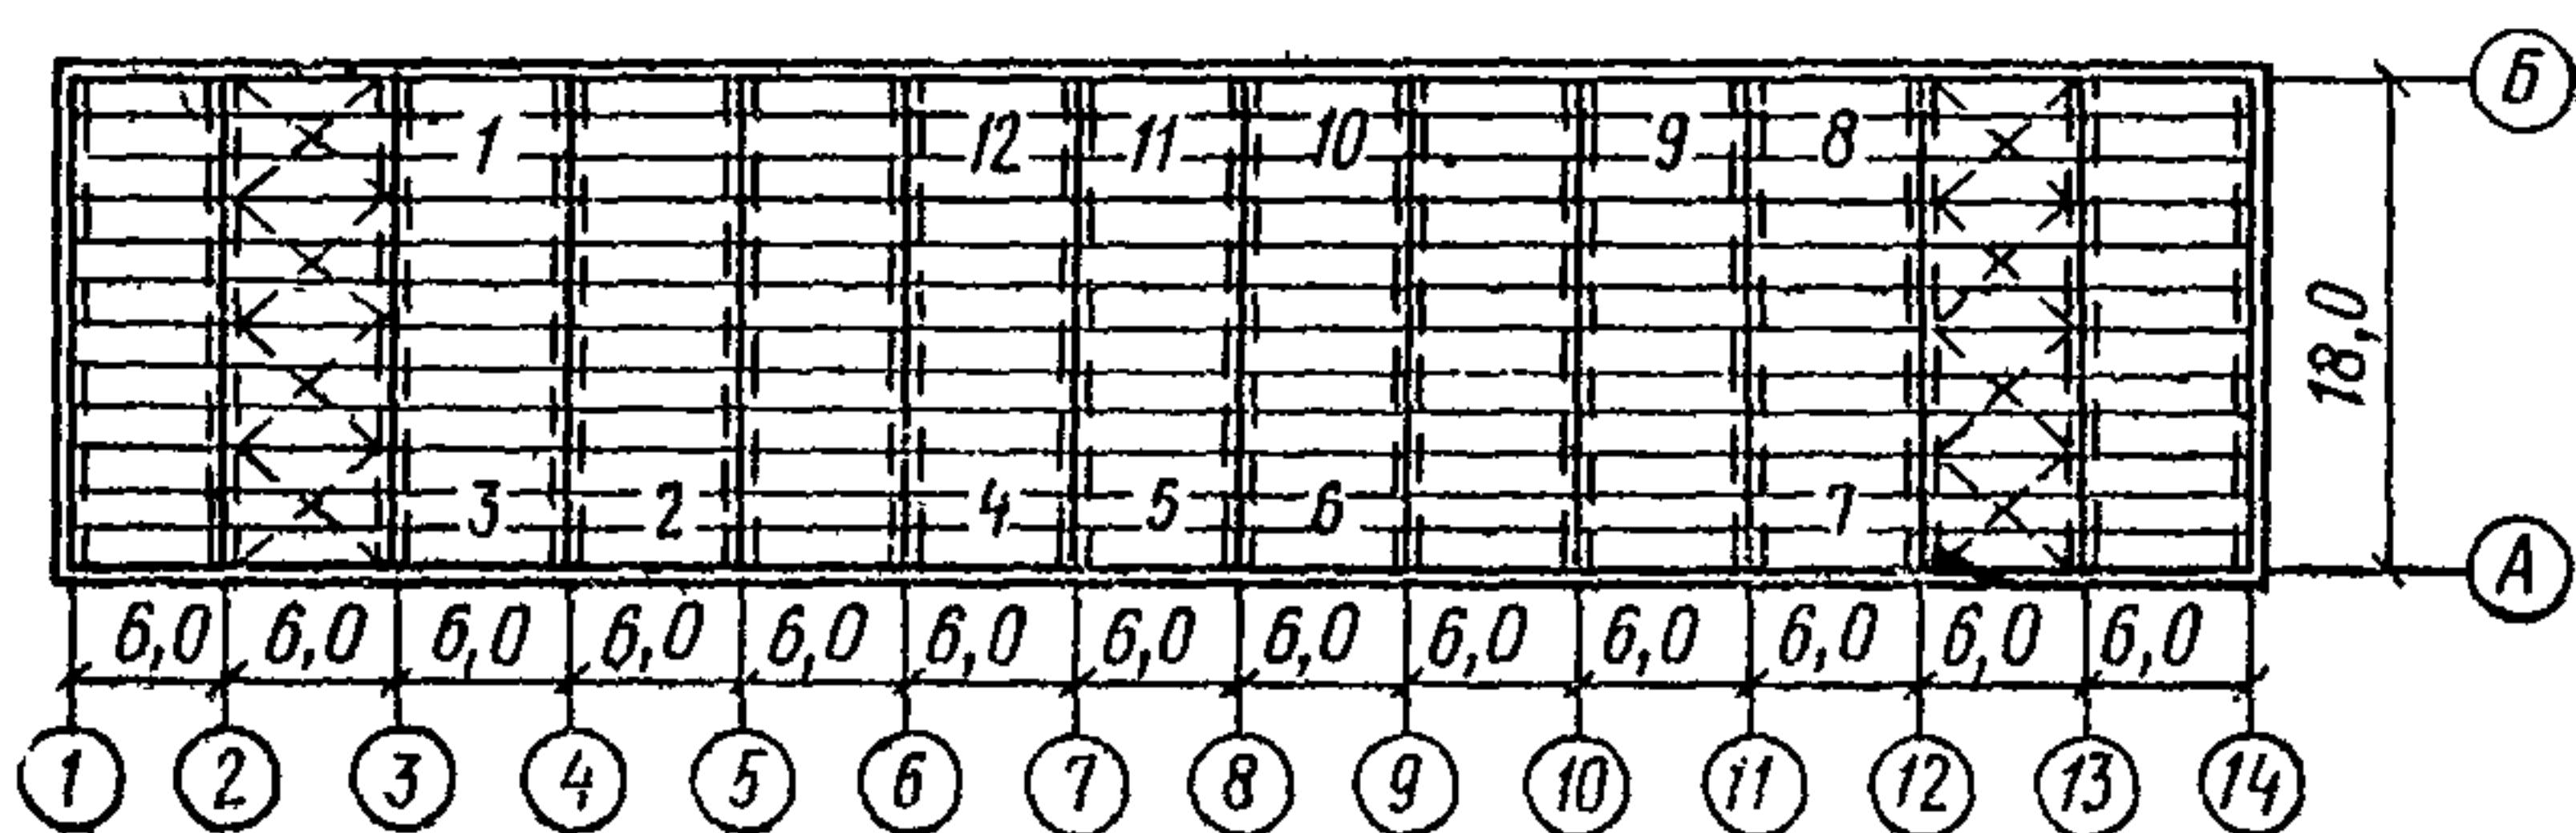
План здания овчарни с применением плит покрытий размером $1,5 \times 6$ м с предварительно напряженными армированными деревянными ребрами
